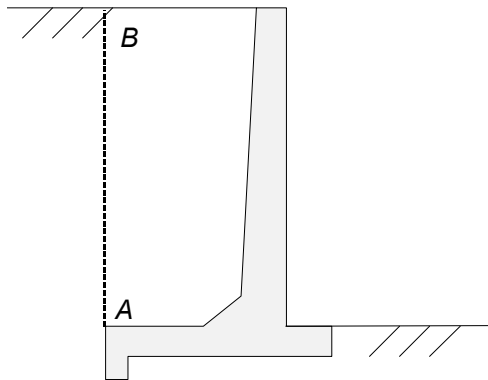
Muro de concreto armado em *L*: seção transversal
